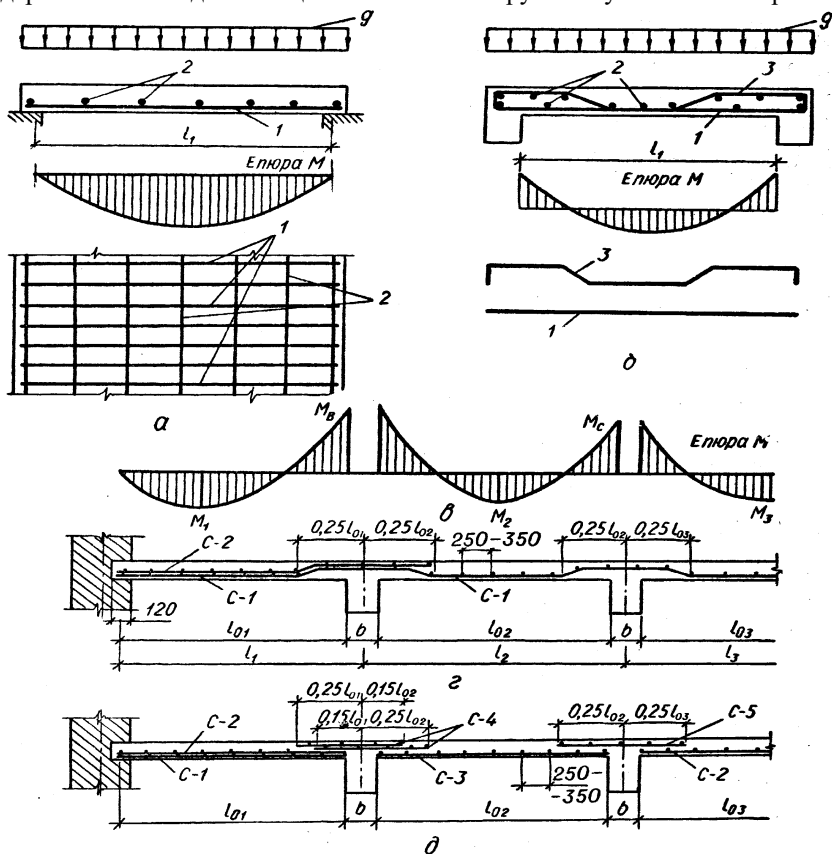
Армування залізобетонних плит: *а* – однопролітної, що вільно лежить на двох опорах; *б* – те саме, монолітно зв'язаної з балками; *в* – епюра згинальних моментів у багатопрлітній плиті; *г* – армування багатопрлітної нерозрізної плити рулонними сітками з поздовжьною робочою арматурою; *д* – те саме, сітками з поперечною робочою арматурою; 1 – робоча поздовжня арматура; 2 – монтажна (розподільна) арматура; 3 – відігнута арматура
